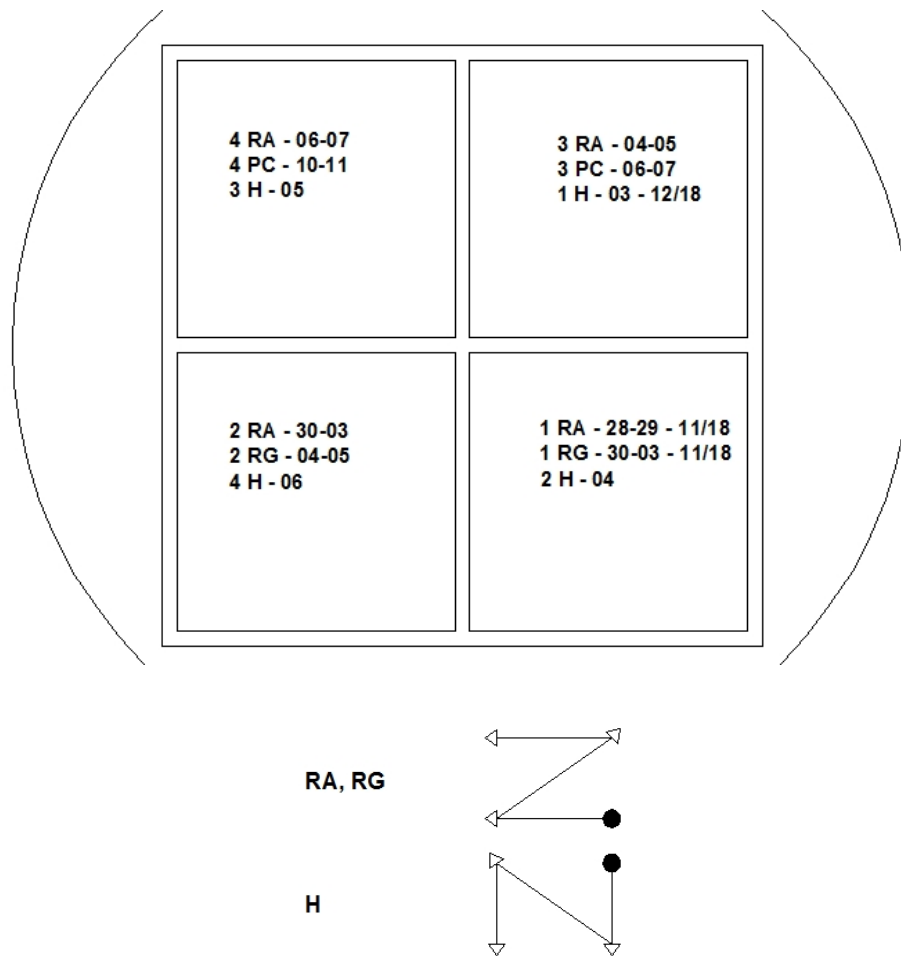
Sequências de execução de FO e PC no 10º pavimento
